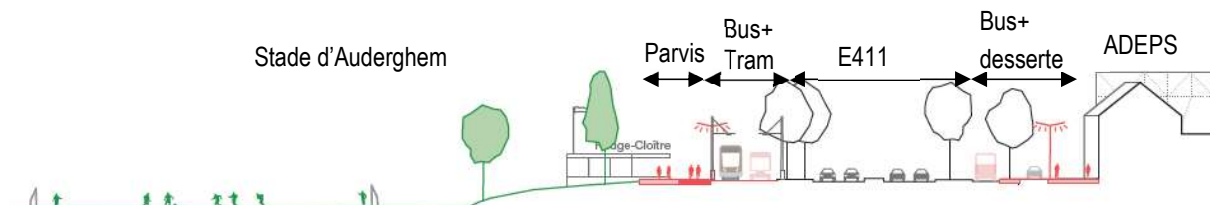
Profil du site Stade – Adeps (ORG², 2018)
